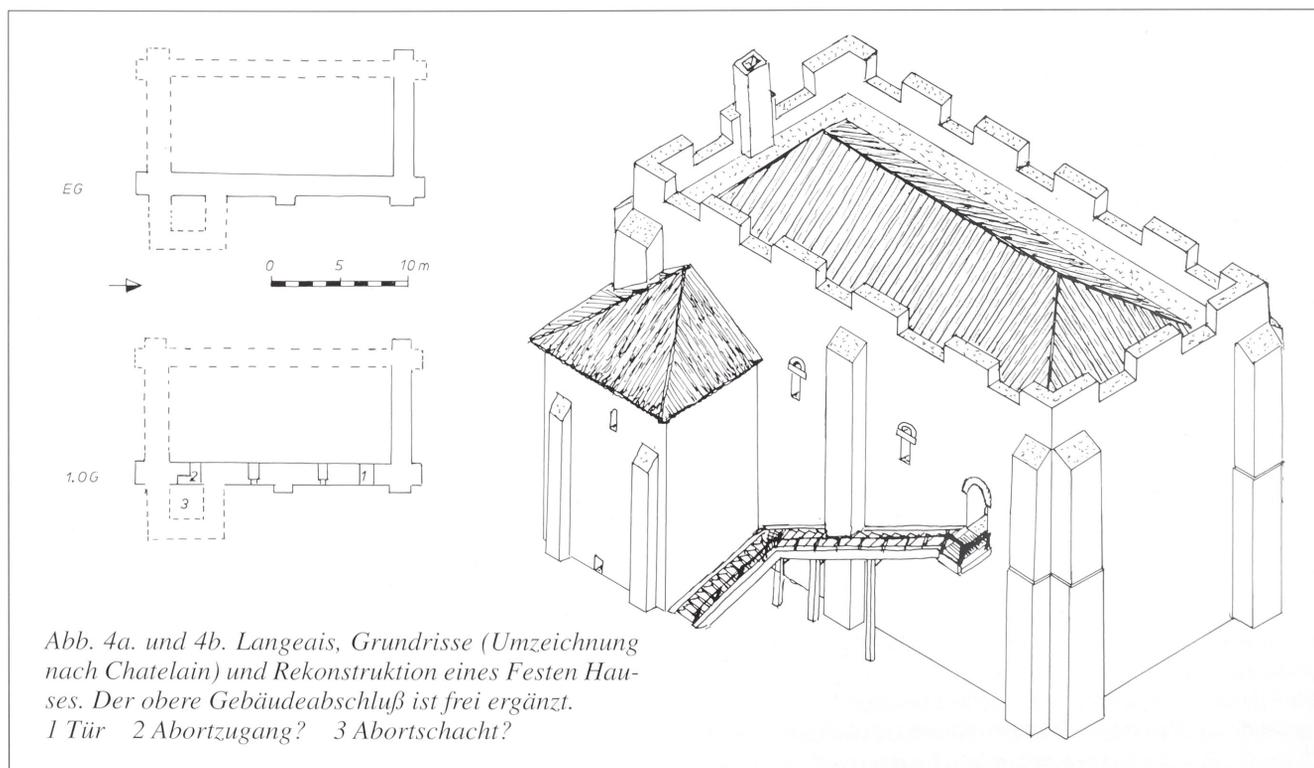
und 4b. Langeais, Grundrisse (Umzeichnung nach Chatelain) und Rekonstruktion eines Festen Hauses. Der obere Gebäudeabschluß ist frei ergänzt.
